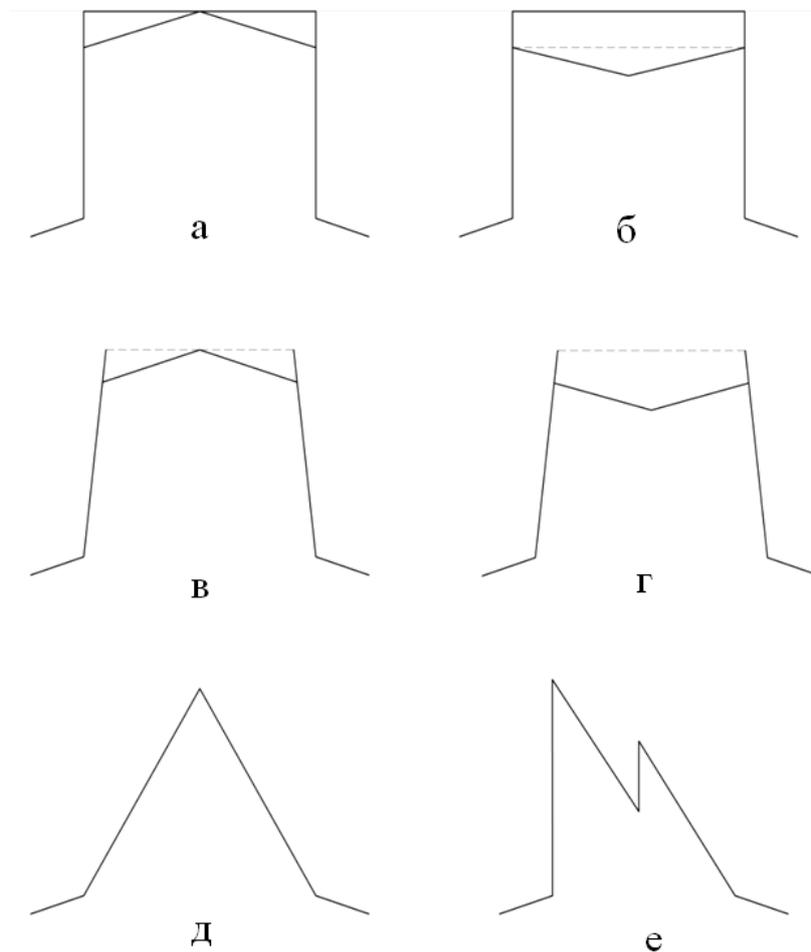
Виды световых фонарей: а – прямоугольный с наружным водоотводом; б – прямоугольный с внутренним водоотводом; в – трапецидальный с наружным водоотводом; г – трапецидальный с внутренним водоотводом; д – треугольный; е – зубчатого профиля
